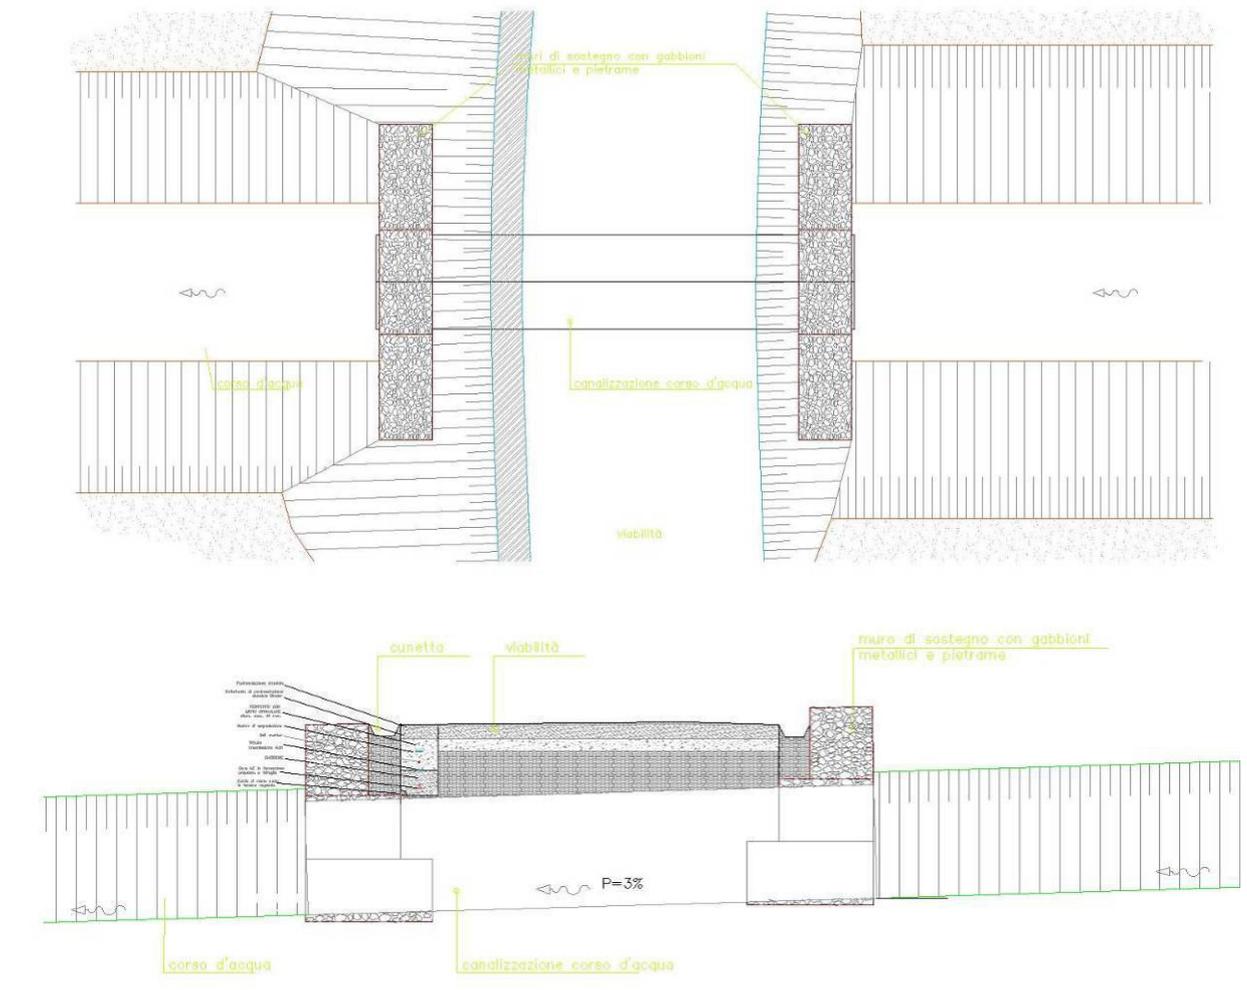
Posa di cavo in scavo in sovrappasso all'impiuvio canalizzato sotto viabilità (pianta in alto, sezione in basso)
